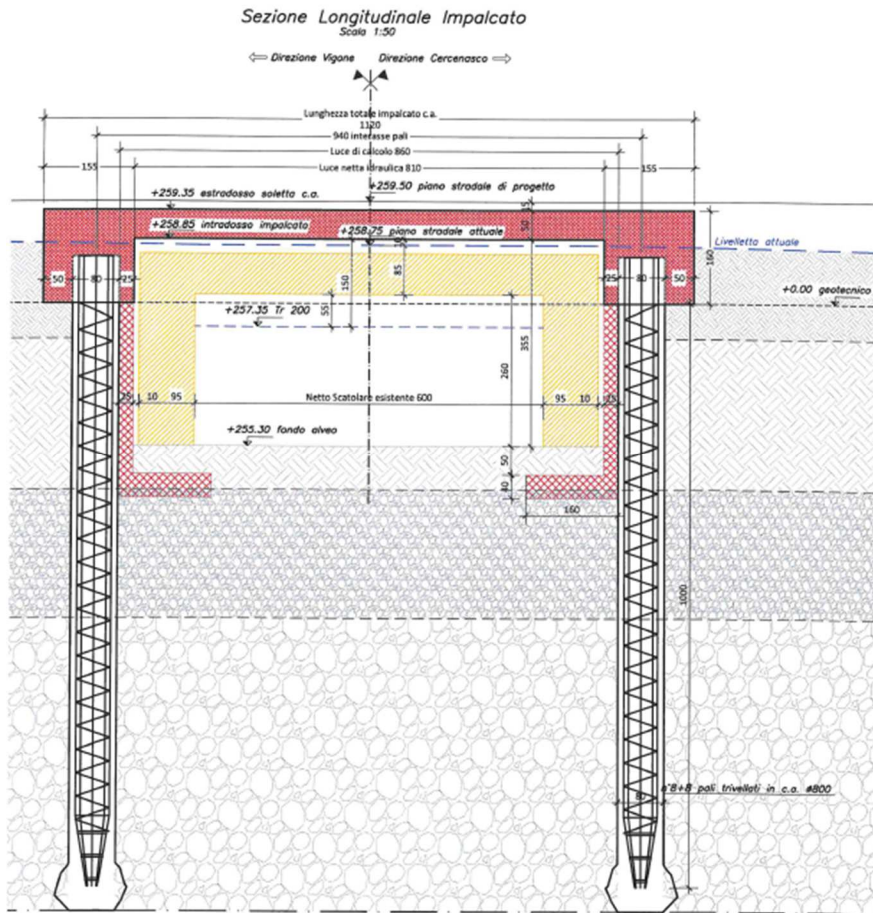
Sezione longitudinale impalcato (elaborato non in scala)
